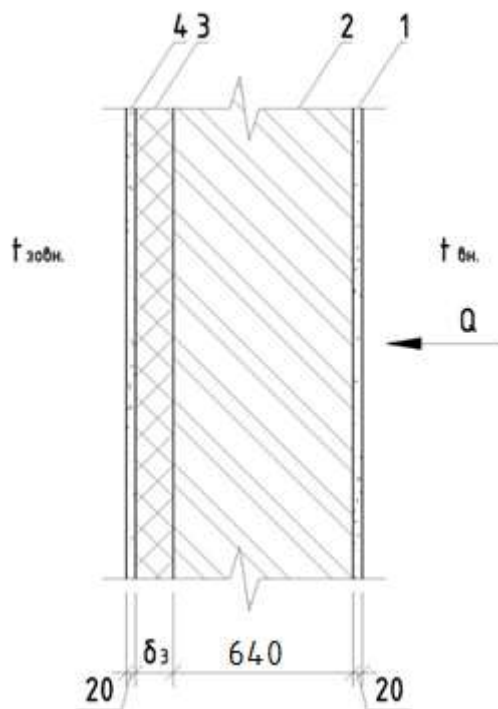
Конструкція зовнішньої стіни типового поверху.
